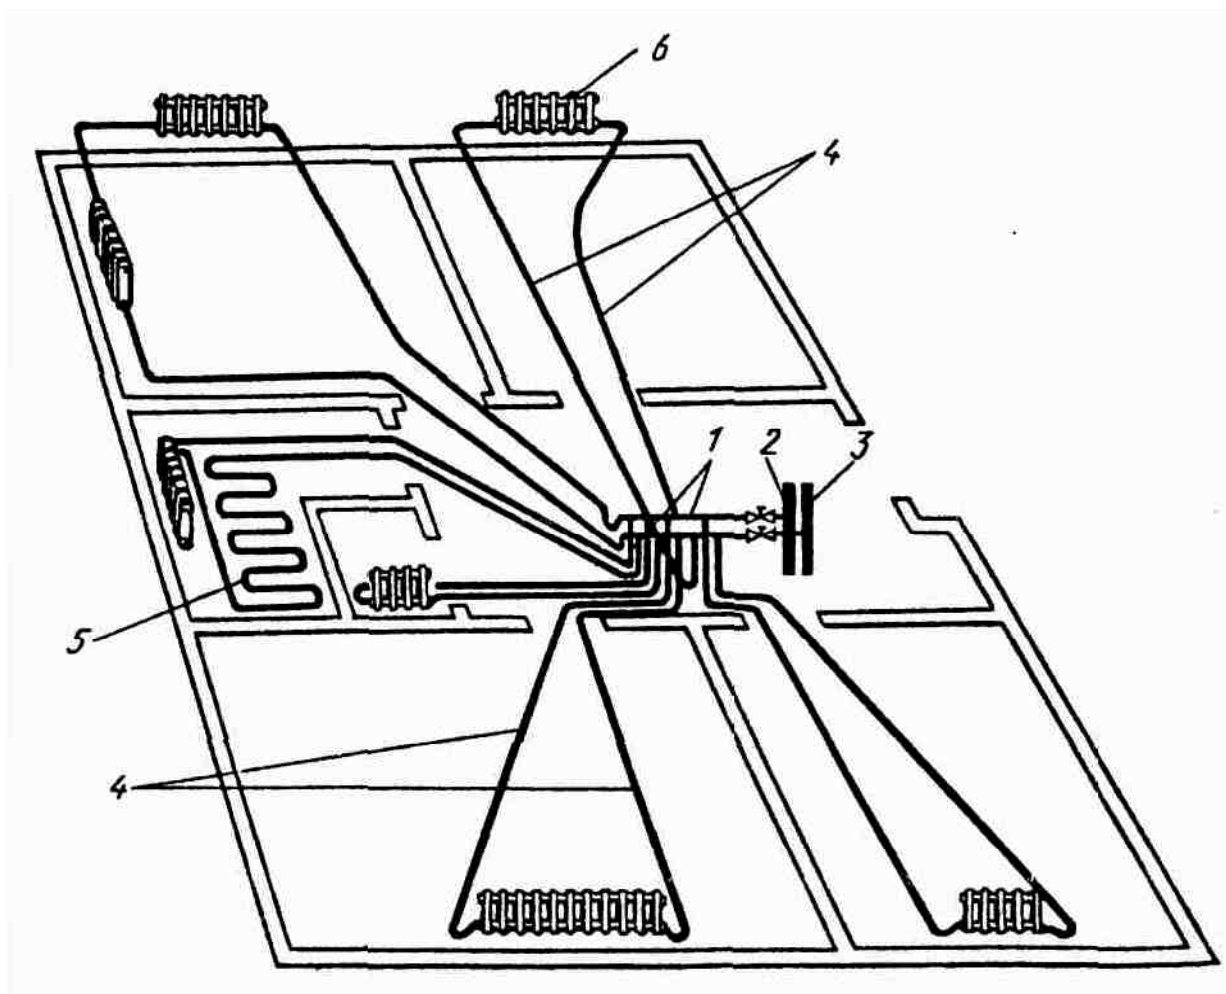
Лучевая схема напольной разводки теплопроводов от вертикальных стояков у внутренних стен: 1 - гребёнка, 2 - подающий стояк, 3 - обратный стояк, 4 - подающие теплопроводы, 5 - теплопроводы напольного отопления, 6 - отопительные приборы
